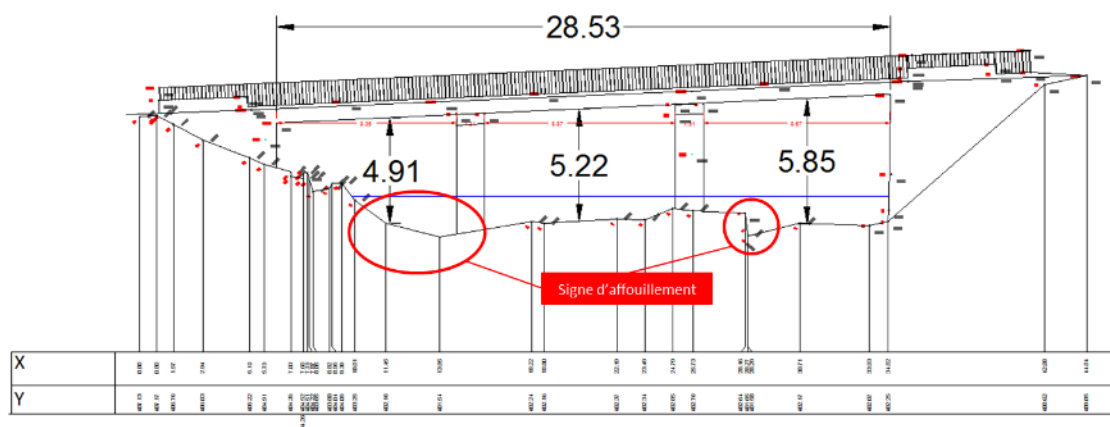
Localisation des signes d'affouillement au droit des piles du pont de la Voyèze
